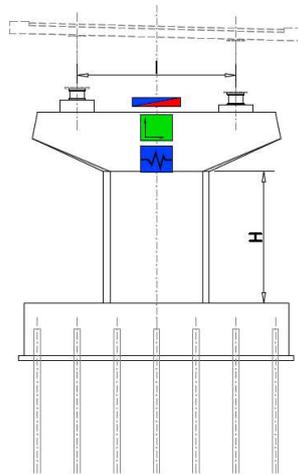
Schema posizionamento strumentazioni pila viadotti
